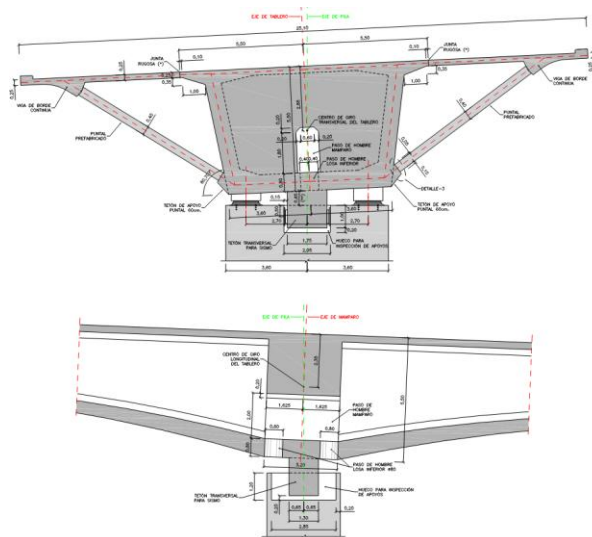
Sección transversal por pila. Definición de posición de los apoyos y del tope transversal
